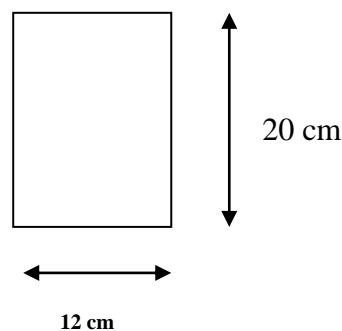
Coupe schématique de la poutrelle (appuis)
